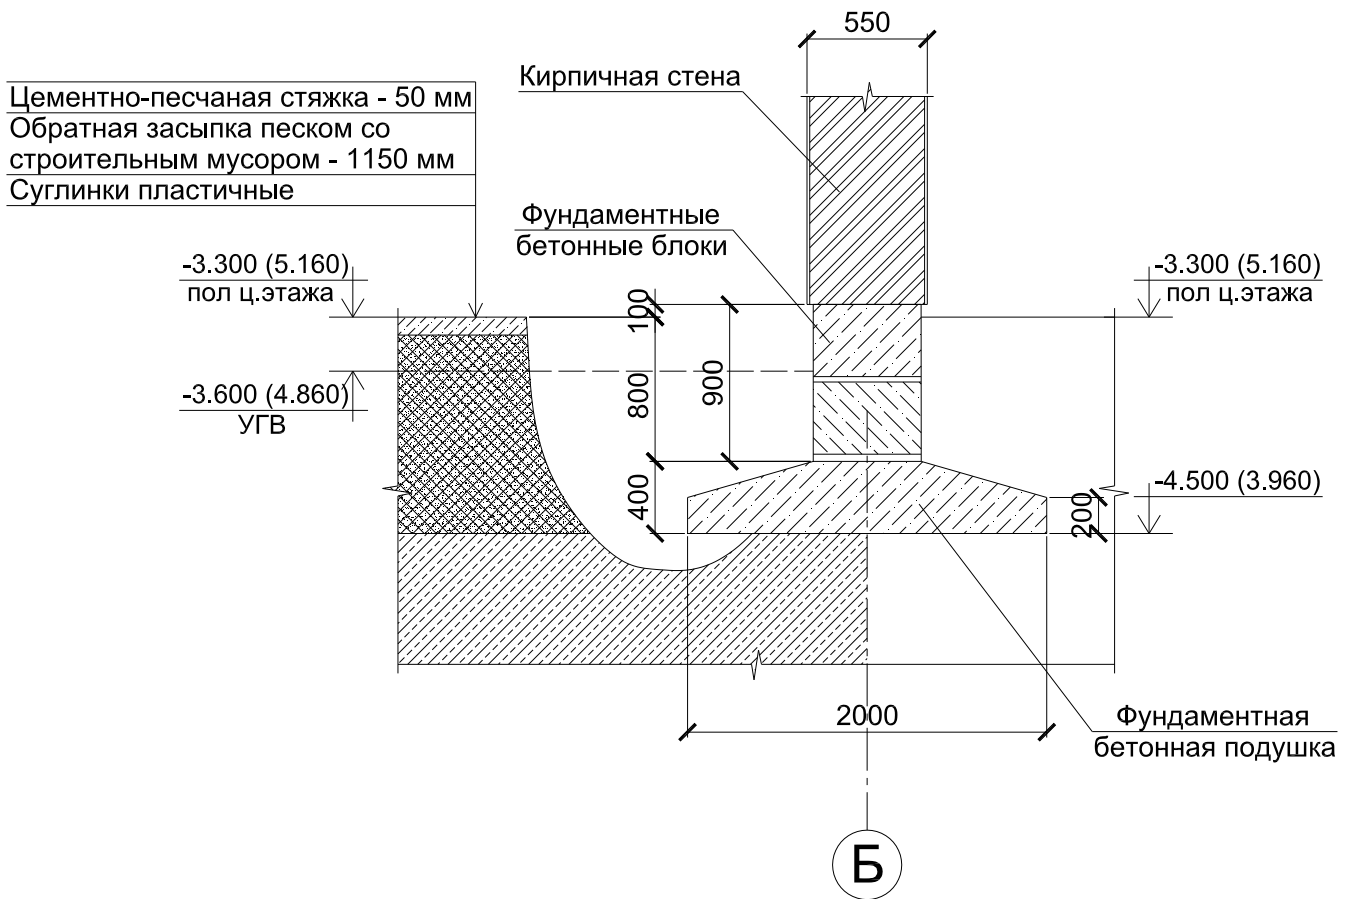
Эскиз поперечного сечения фундамента.
